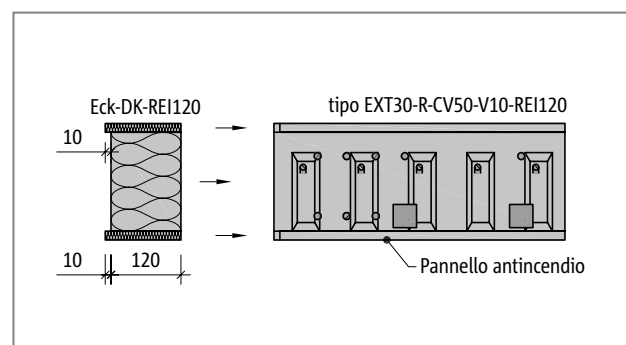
Schöck Isokorb® tipo EXT30-R-CV50, REI120: vista dell'elemento
